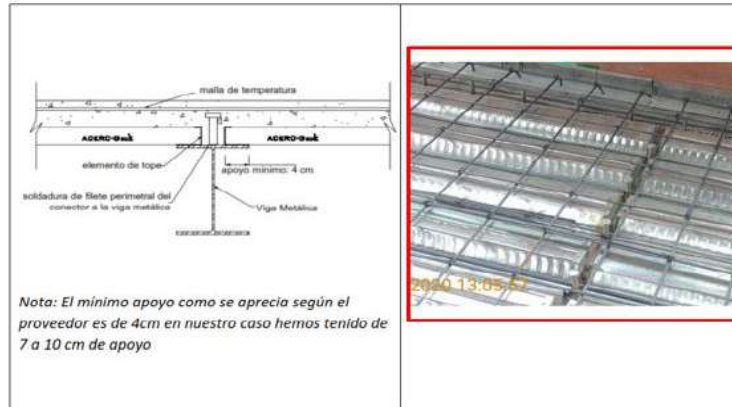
Apoyo de placa colaborante sobre viga tipo B
